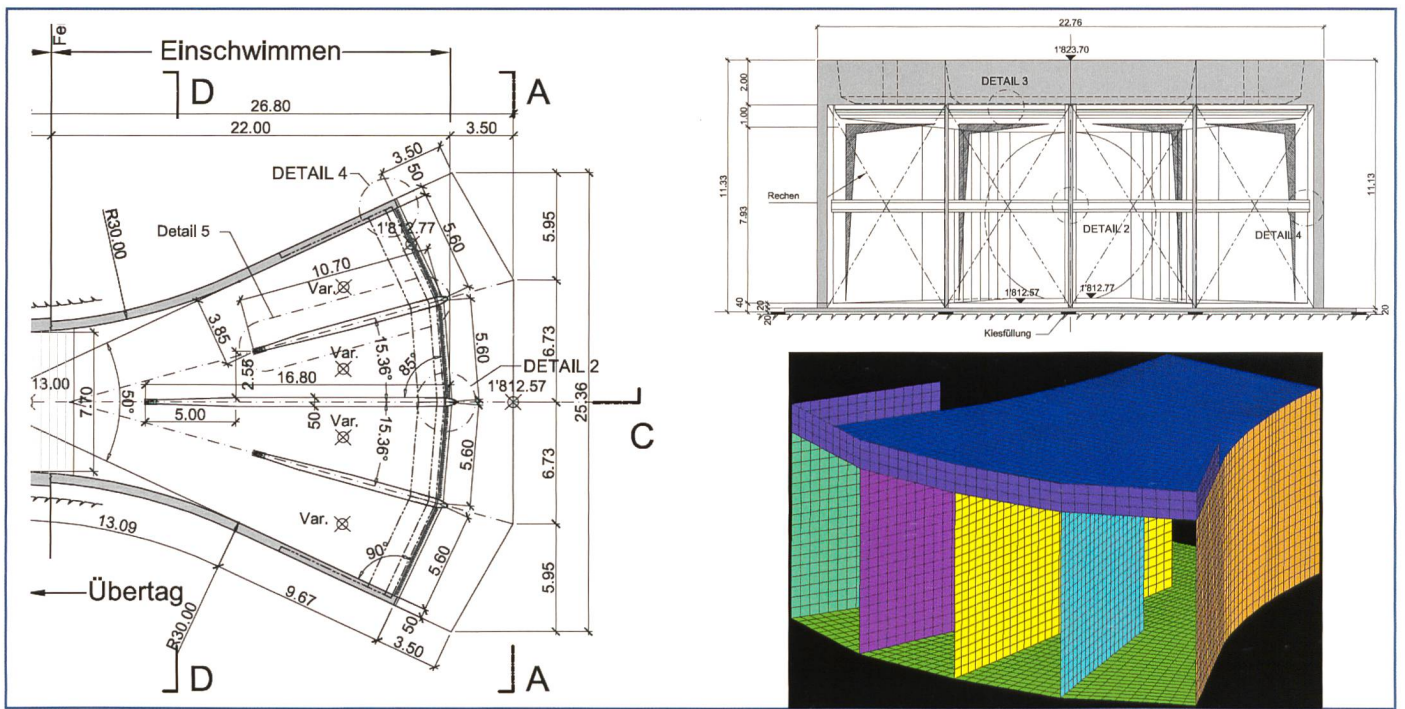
EAU im Grundriss (links oben). Bild 6.2. EAU Ansicht (rechts oben). Bild 6.3. Statisches System in 3D-Modell (rechts unten).
